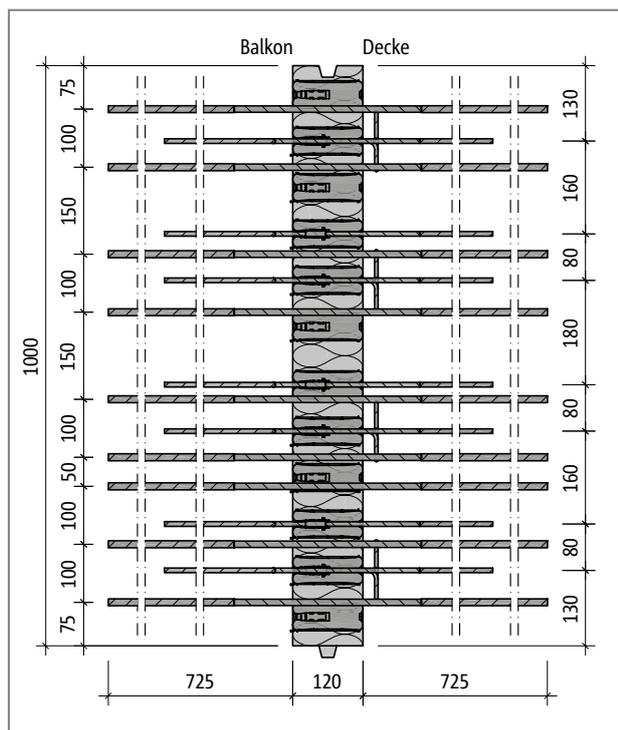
Schöck Isokorb® Typ KXT65: Produktgrundriss
